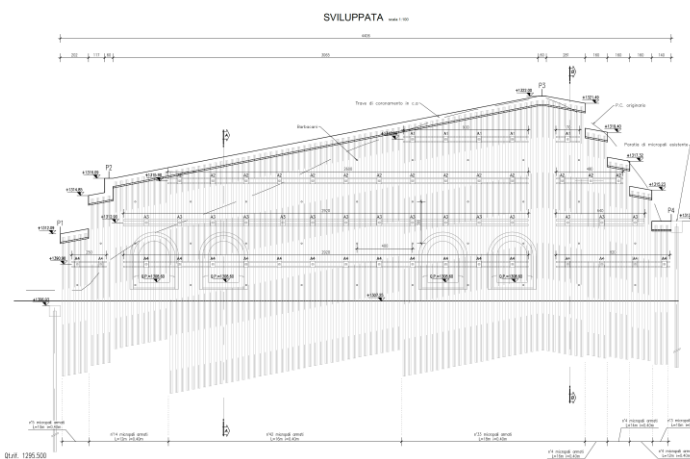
Prospetto paratia cunicoli di ventilazione
